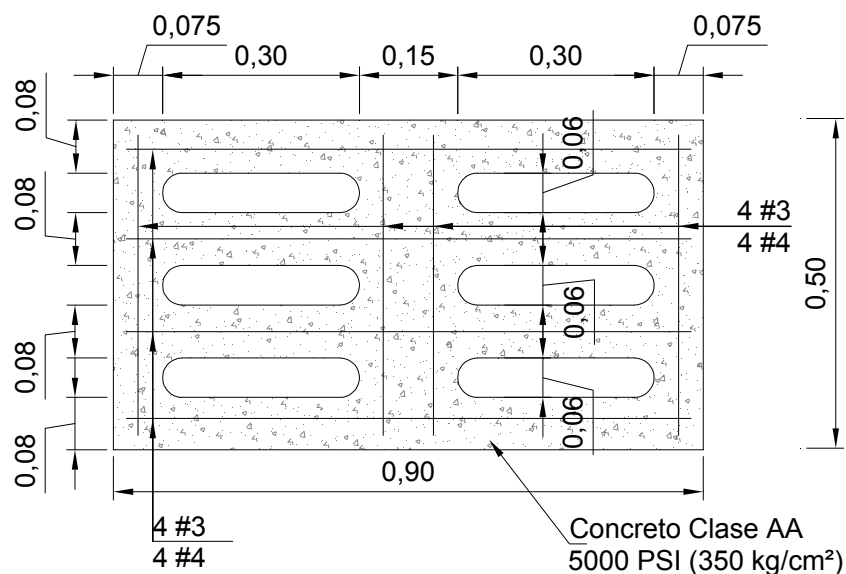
Planta de Rejilla Horizontal de Sumidero
